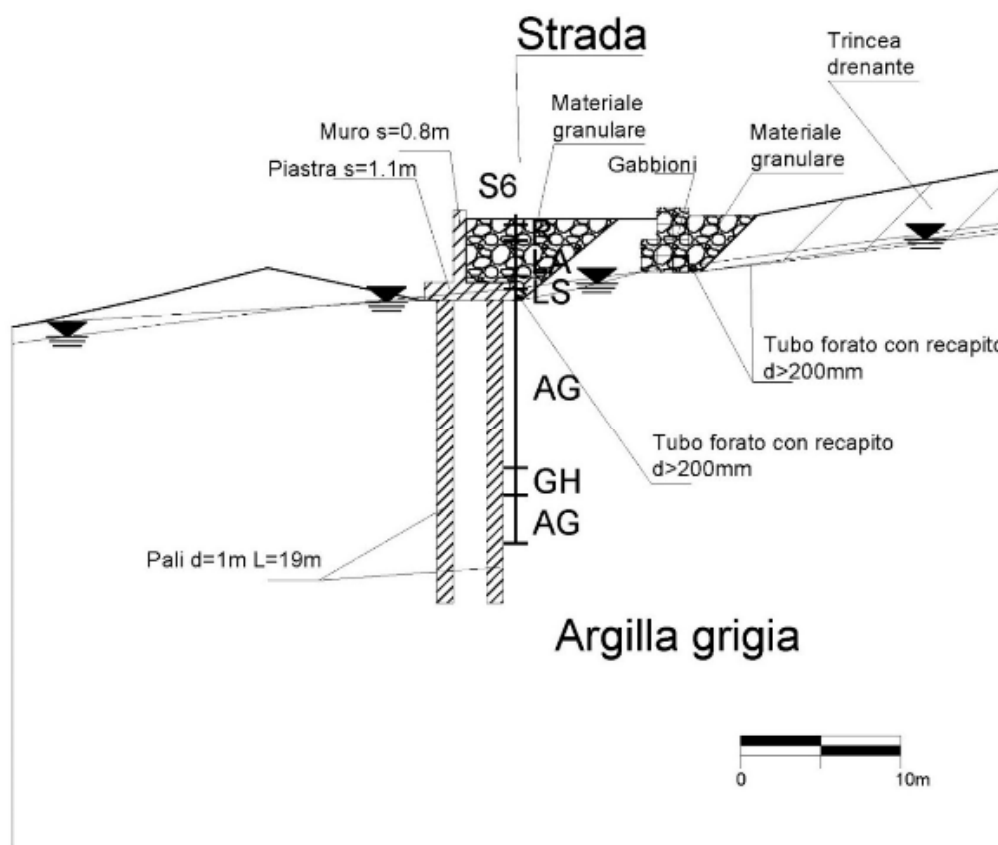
Dissesto al km 9+300. Sezione con schema degli interventi di consolidamento. Particolare in corrispondenza della strada. Sulla mensola verticale del muro si predisporranno fori drenanti.
